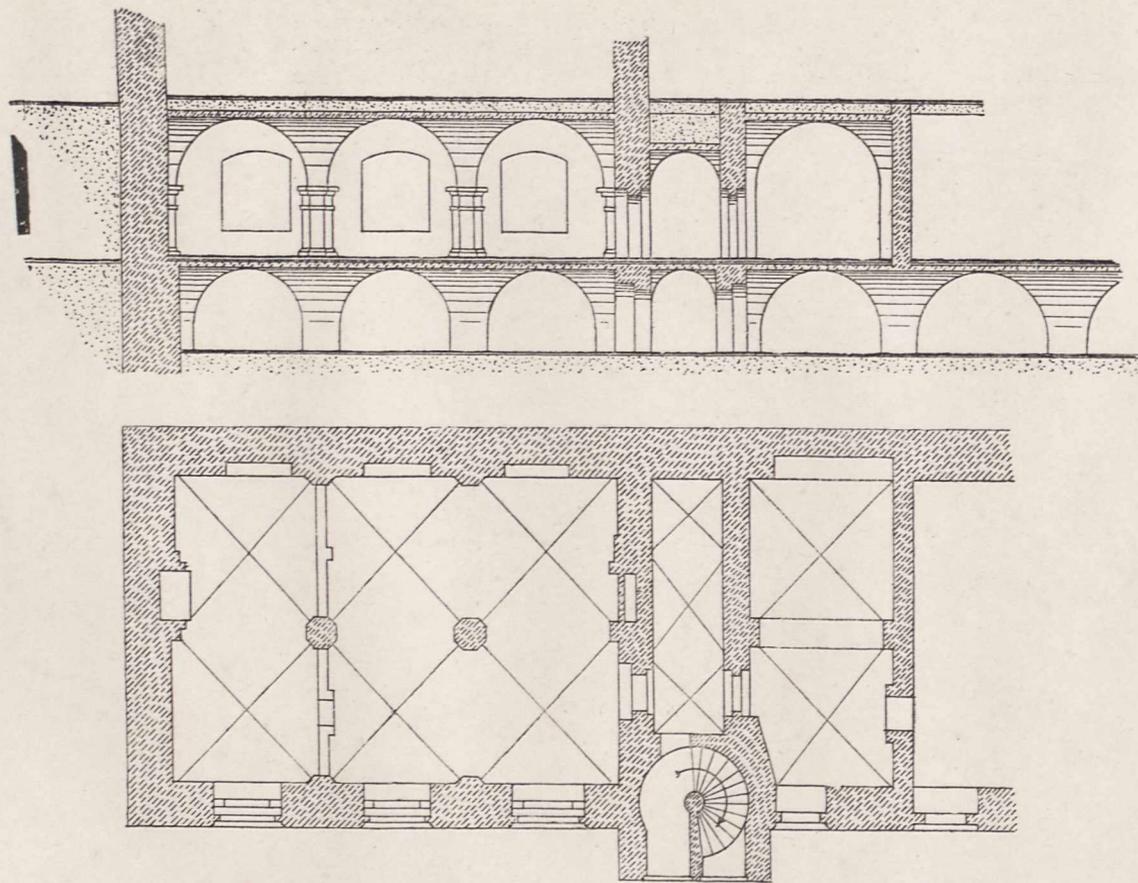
Spantekow; Schloss, Grundriss und Längsschnitt des Remters und der anstossenden Theile des Erdgeschosses. 1 : 250.
